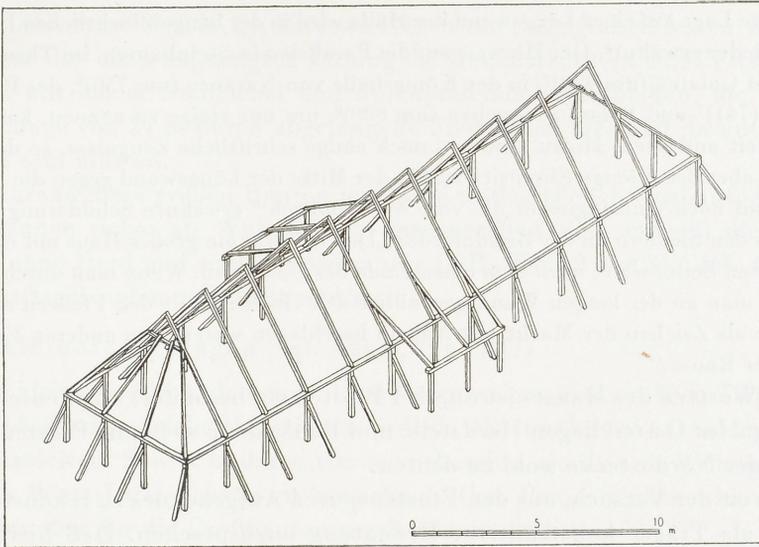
Warendorf. Rekonstruktionsschema vom Gerüst eines Wohnhauses (Haus 7 Planquadrat C/D-6/7 Beilage 4; Abb. 4, I). M. 1 : 300.
